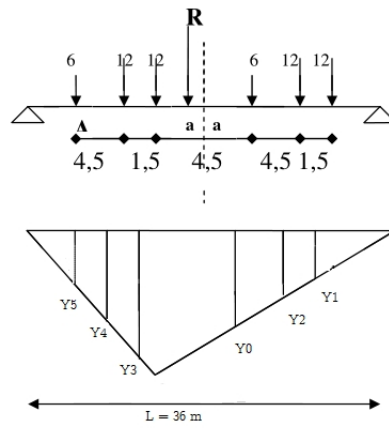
Poutre sous la surcharge Bc cas 2
